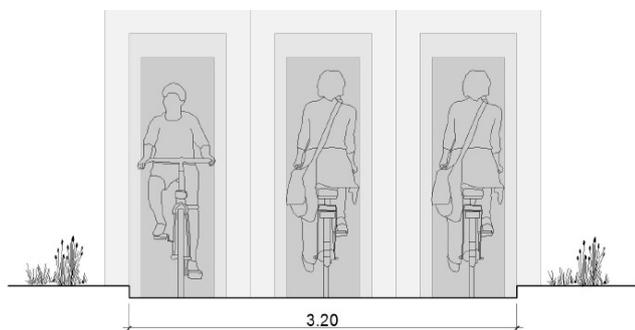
Croisement de trois vélos sur une piste cyclable bidirectionnelle (en site propre)
